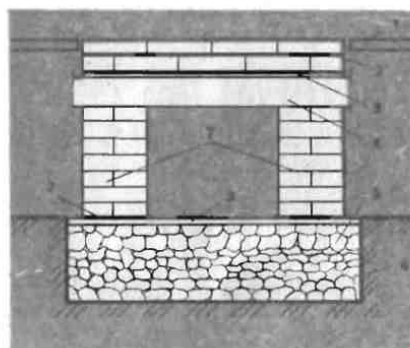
Сплошной фундамент в грунте, сопряженный с наружным фундаментом из двух столбиков, перекранных железобетонными перемычками
